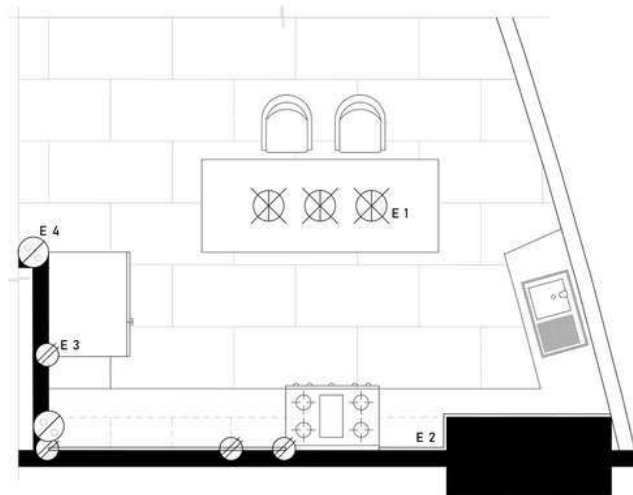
Planta de cocina, instalaciones eléctricas. Fuente: Autoría propia.
